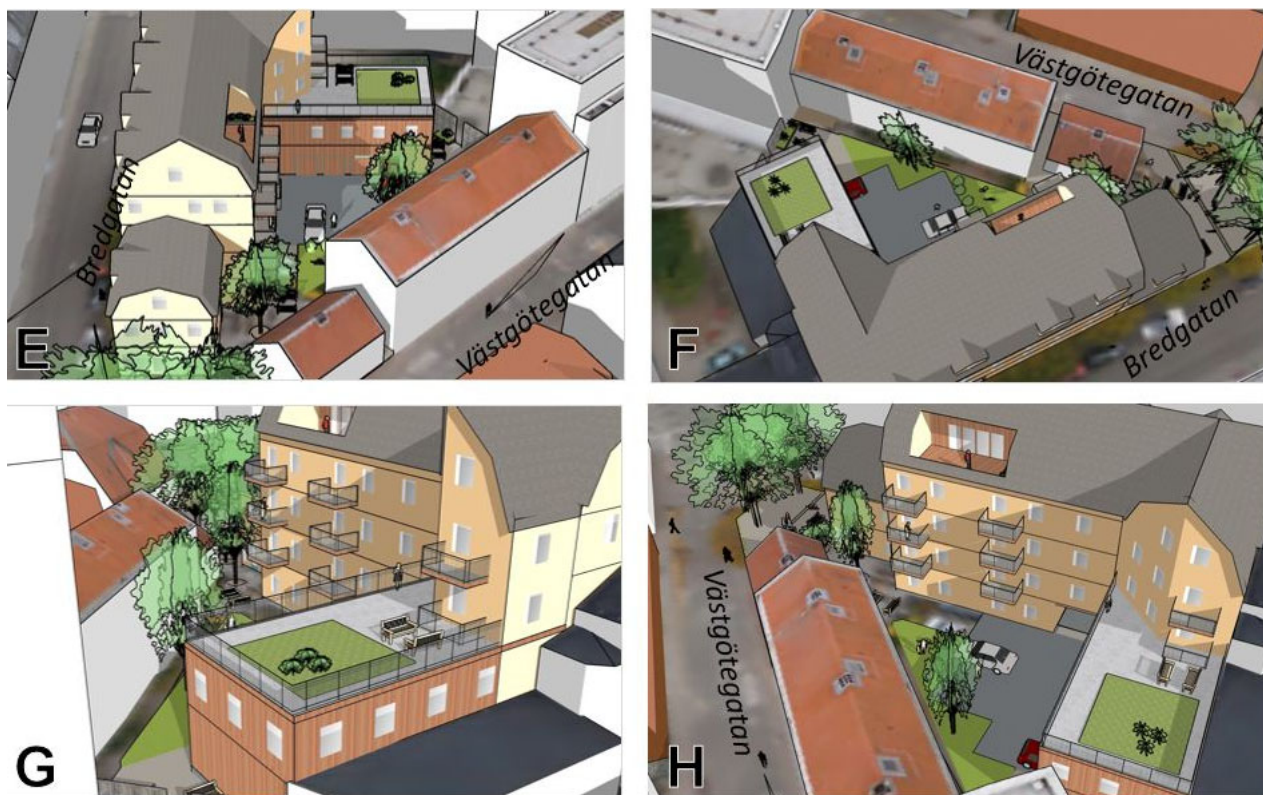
Bilden ovan visar en översiktlig vy över planområdet och de föreslagna byggnader och åtgärder enligt granskningsförslaget. Byggnader med helvita fasader är befintliga.
